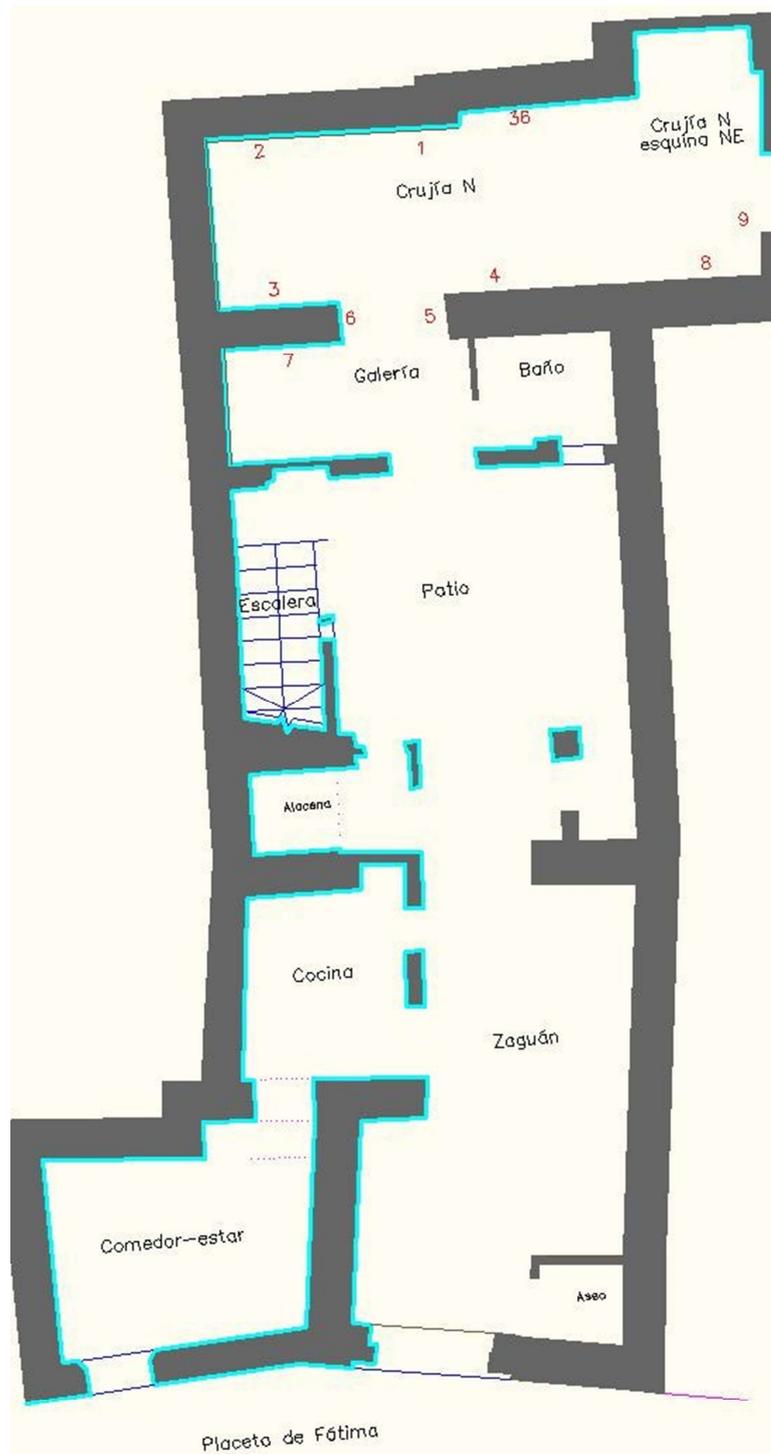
Ubicación de las catas en la Planta Baja (numeración en rojo).
